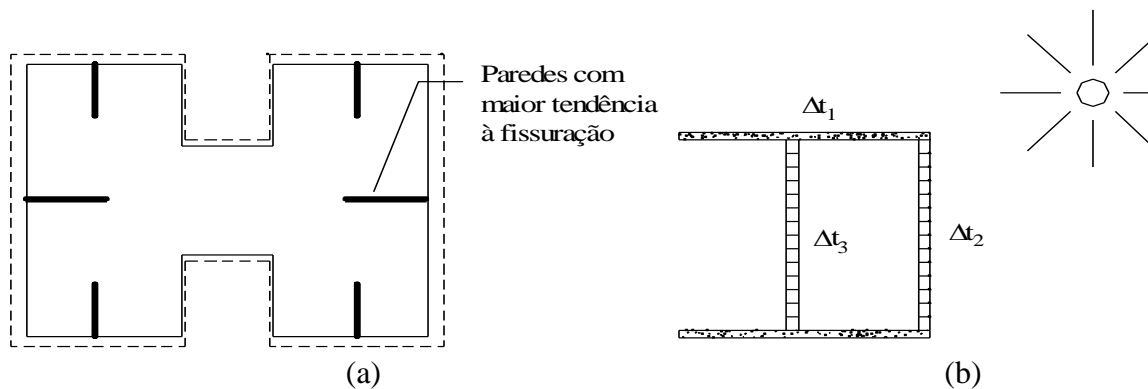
Deslocamentos das lajes e paredes com maior tendência à fissuração.
